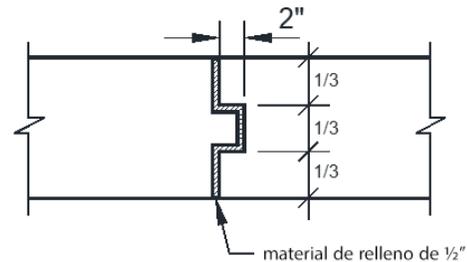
DETALLES DE JUNTAS DE EXPANSIÓN PARA CONCRETO
